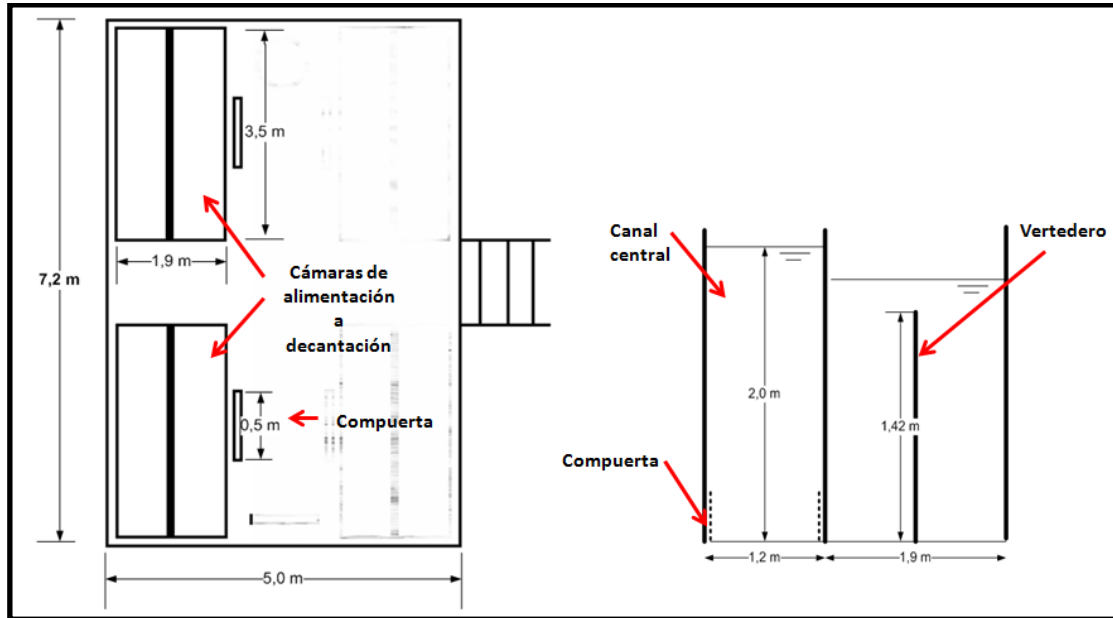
Esquema de la Arqueta de distribución Planta Potabilizadora Sistema Aislado de Camatagua.
